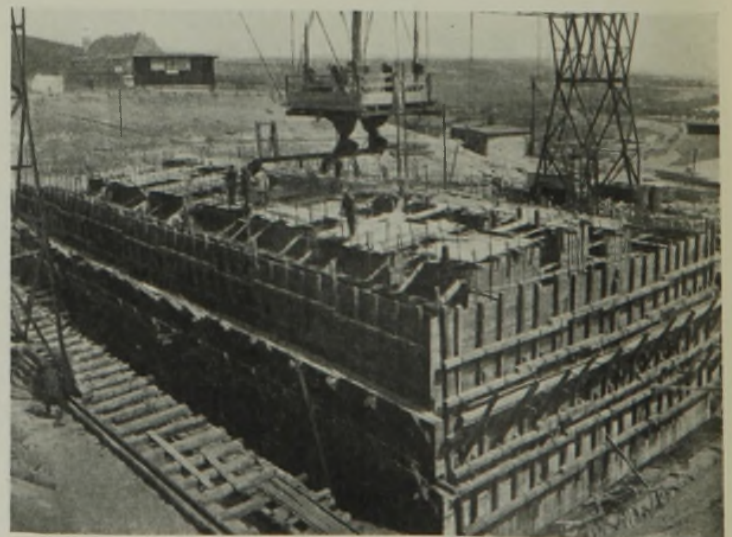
Westpfeiler während des Betonierens bis zu den Trägerobergurtungen, d. i. rd. 6 m über der Schneide; Verfahren des Kranes mit Betonierbühne und hochgezogenen Gießbrinnen.
